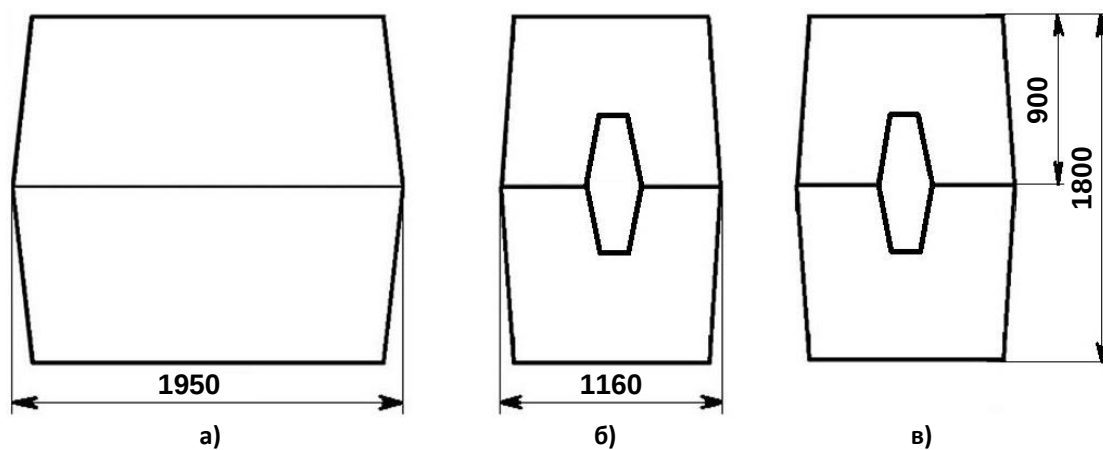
Габаритные размеры колодца «ККСр-3-80»:
